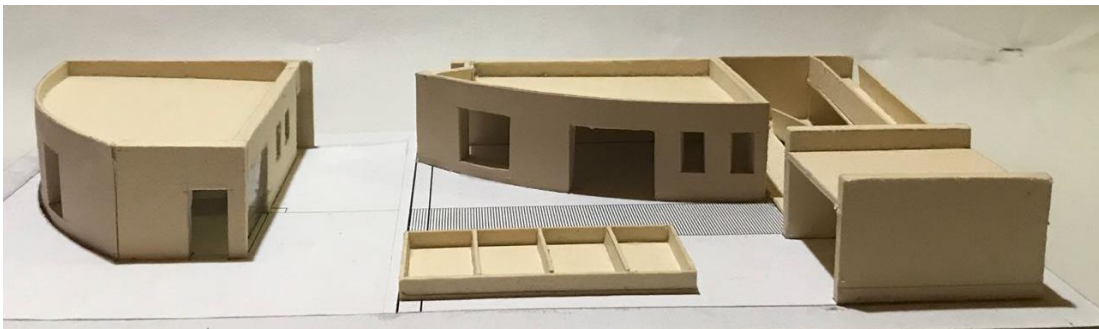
Maqueta vista fachada principal. Fuente: Elaboración propia.
